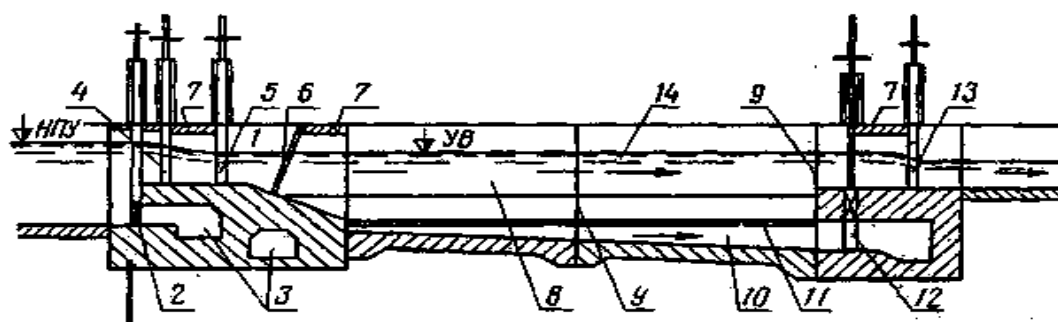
Продольный разрез отстойника с непрерывной промывкой, расположенного в водозаборном узле:
